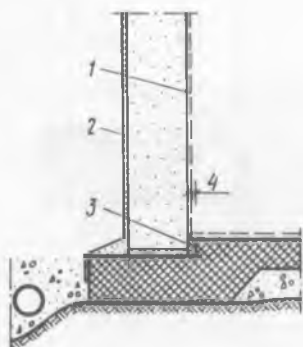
Деталь соединения со сборной фундаментной плитой из плотного бетона
